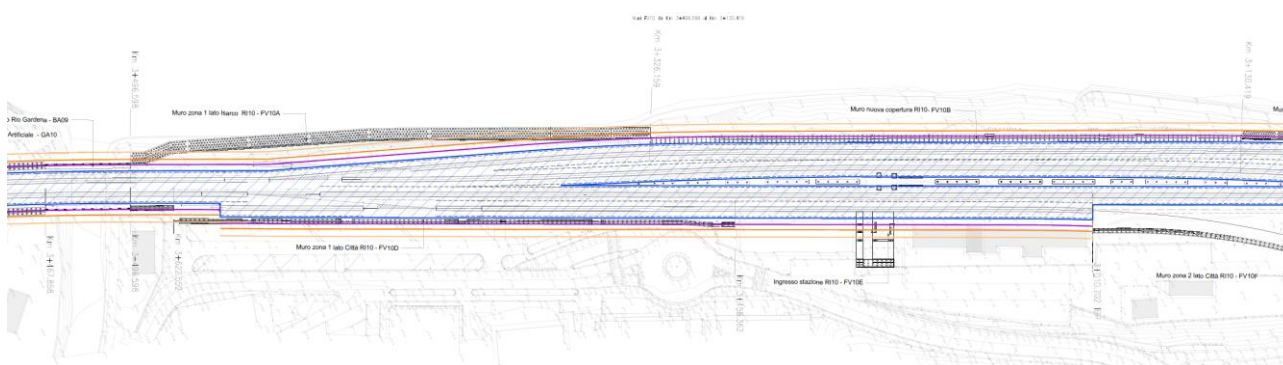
Stralcio planimetrico delle distanze di sicurezza
